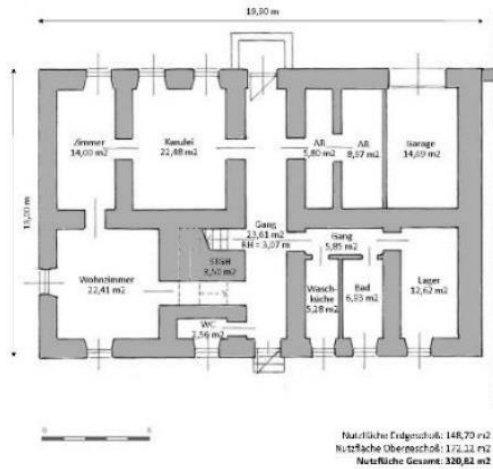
Grundriss Erdgeschöß, Pfarrhaus Winden am See.
